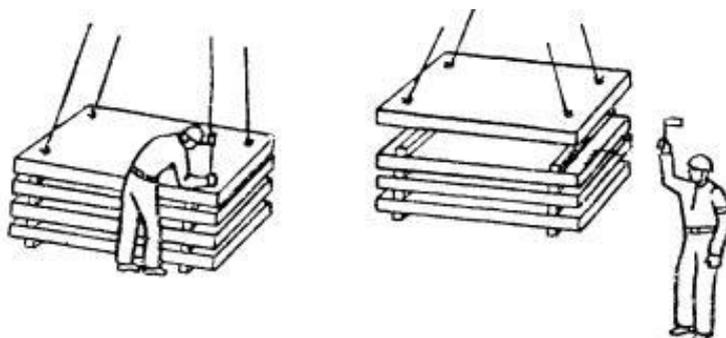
Строповка и подача плиты к месту укладки
